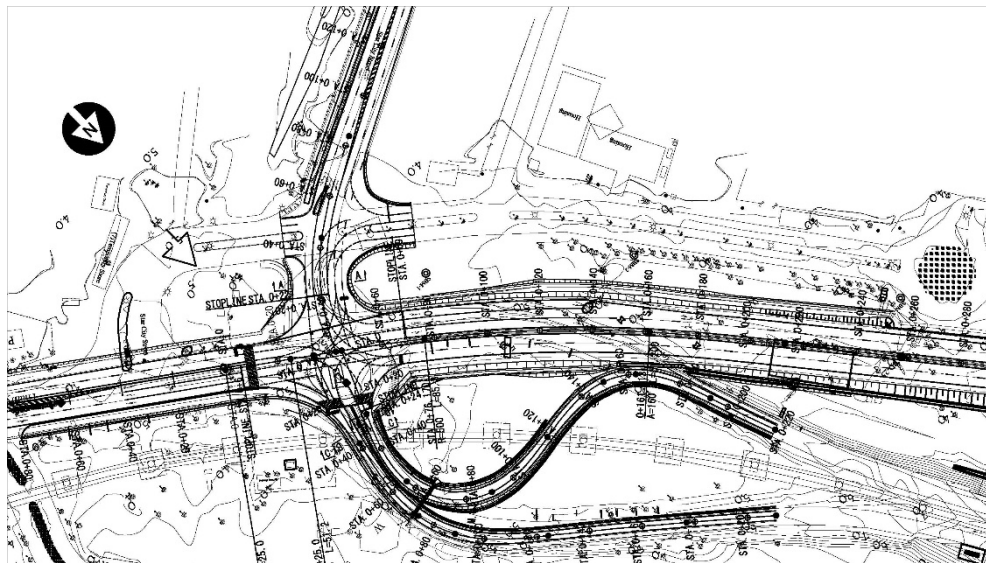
既設ヤンゴン-タンリン橋に至る取付道路の移設計画平面図
